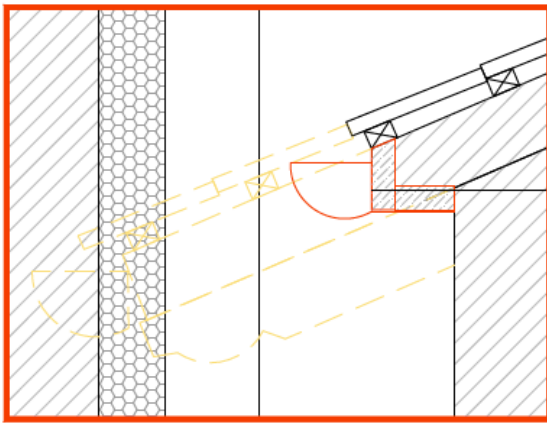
dettaglio arretramento tetto e implementazione lattoneria
